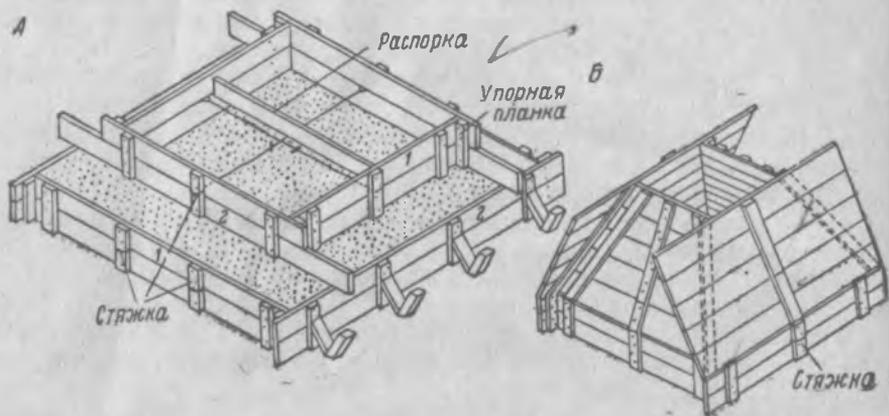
Опалубка фундаментов под колонны: А — прямоугольных, Б — пирамидальных
